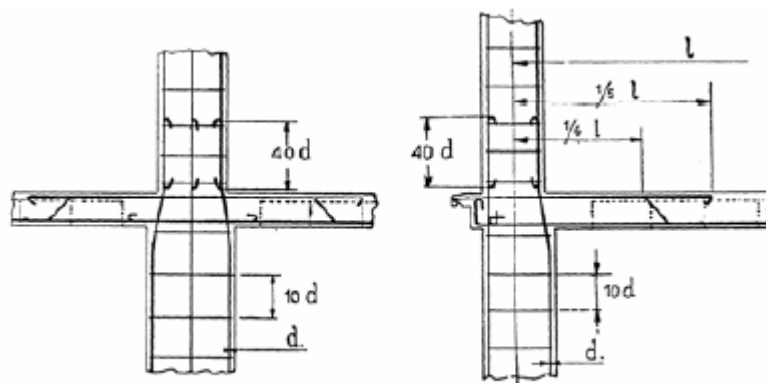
Disposizione delle armature nei pilastri (Santarella) [6].
